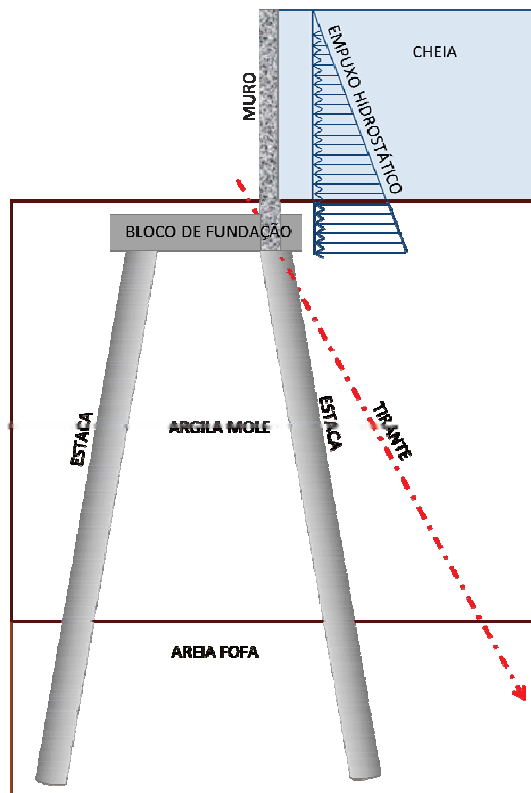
Esquema estrutural do muro de flexão estaqueado / atirantado
